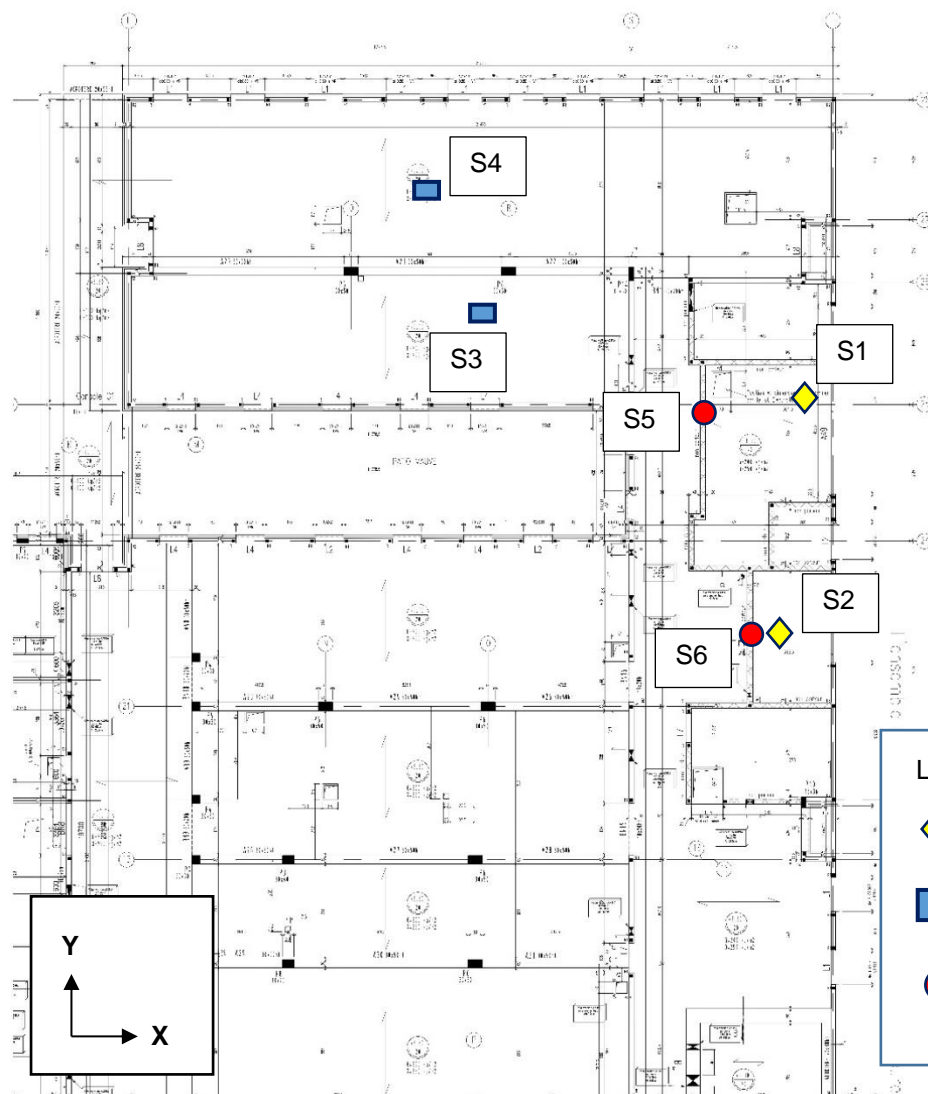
Implantation des sondages sur le plan de structures au PH RDC
